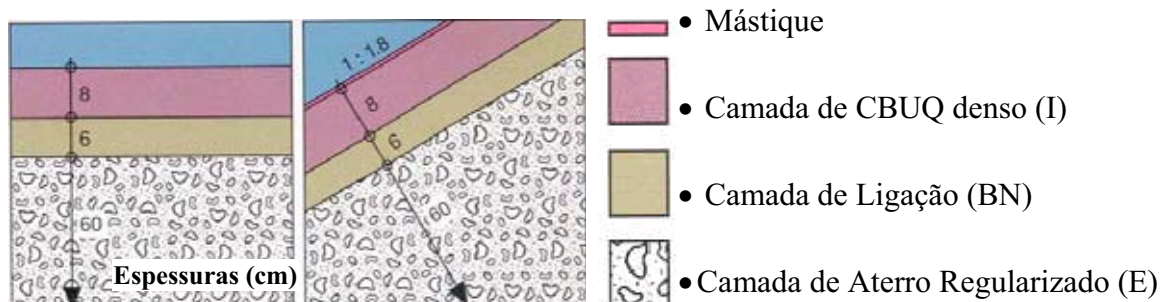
Configuração das camadas do canal Lech, Alemanha (Walo, 1997a).
